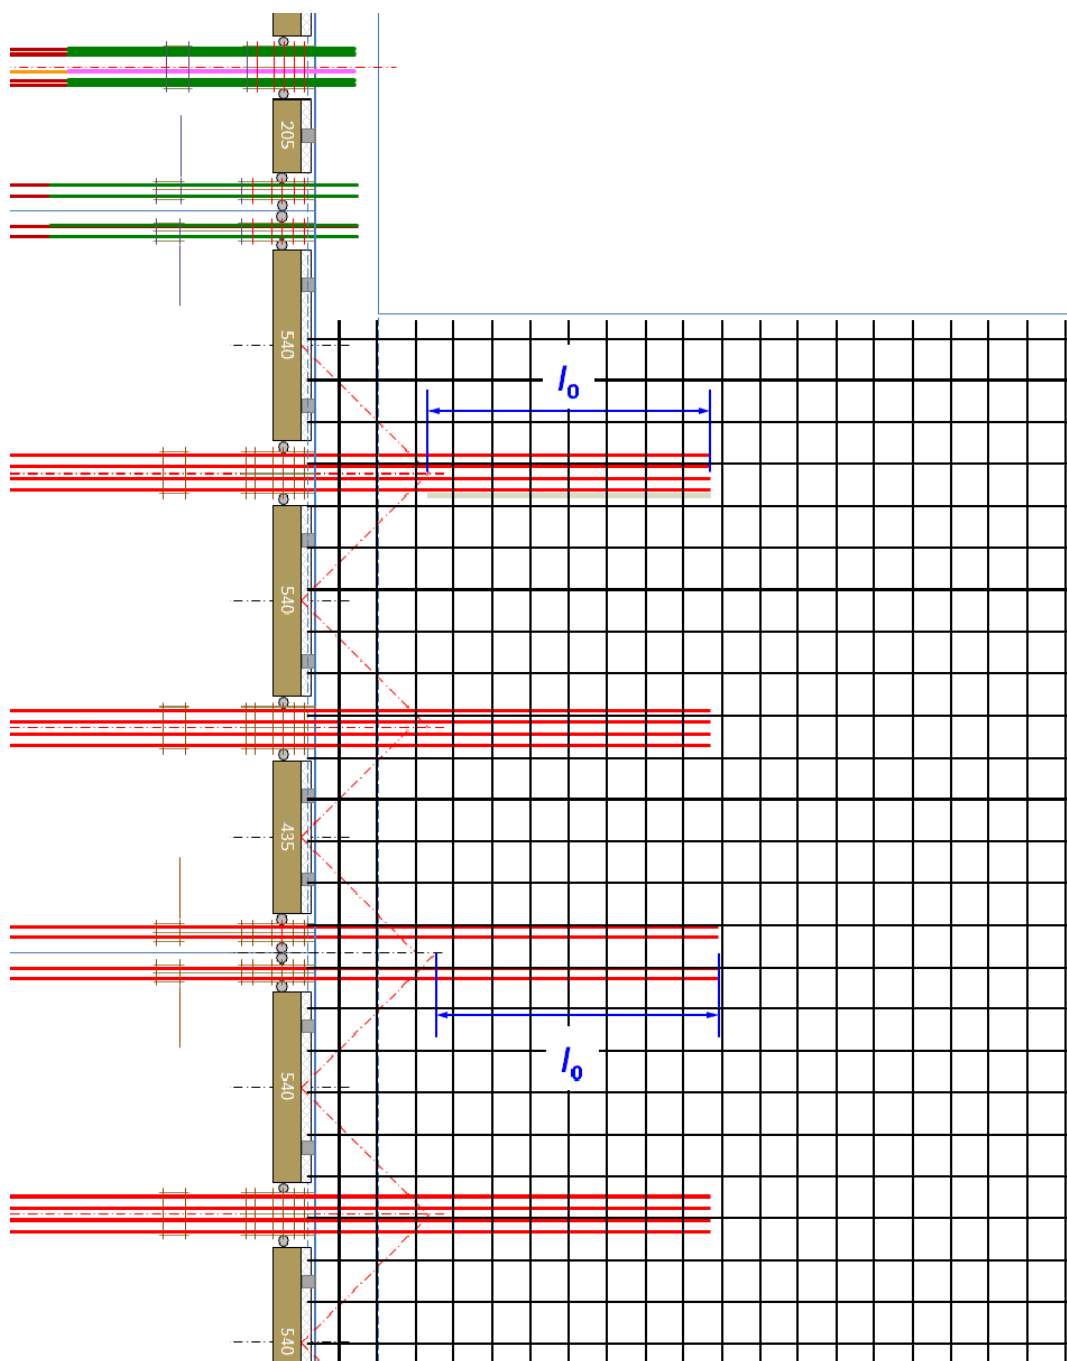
Vue en plan - Détermination de la longueur de la zone de recouvrement
